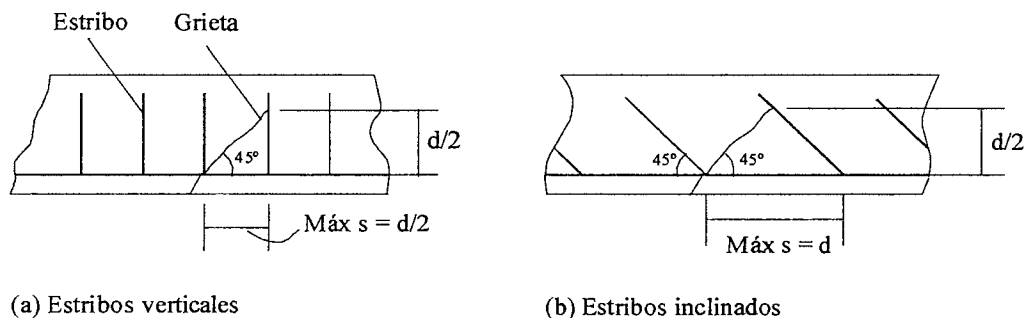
Espaciamiento máximo de estribos para interceptar una grieta inclinada.
